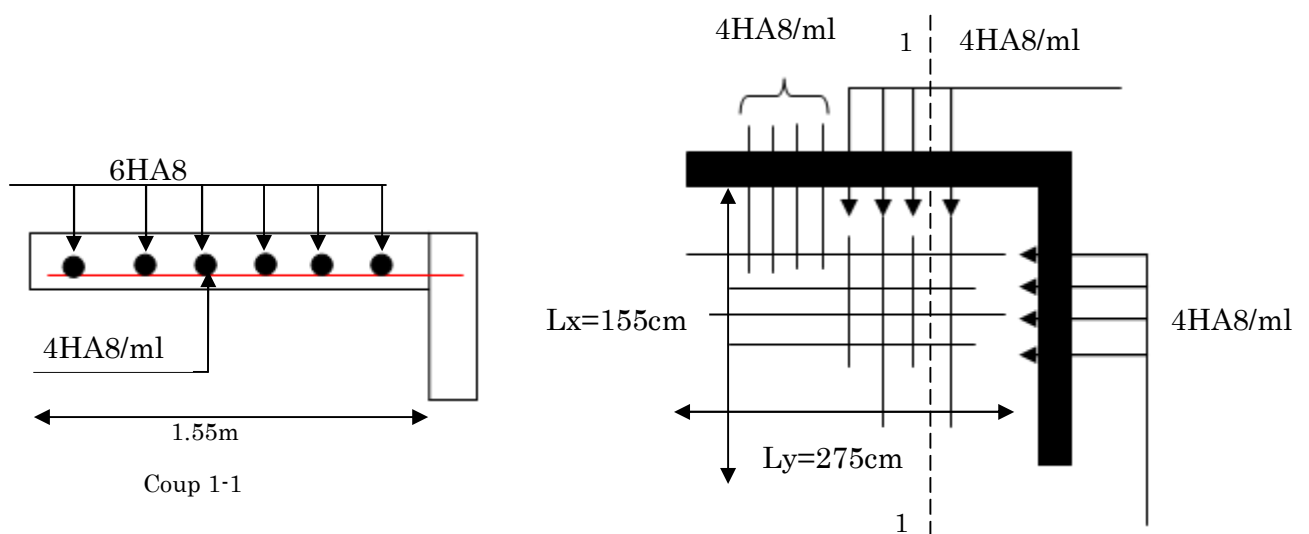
Schéma de ferrailage de la dalle sur 2 appuis
